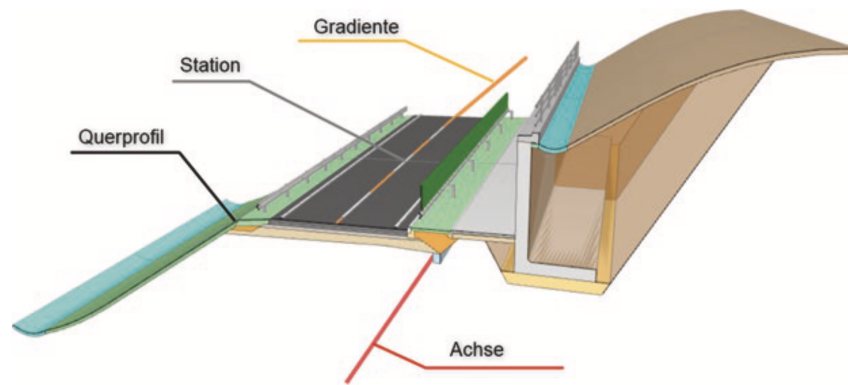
Grundelemente der Straßenplanung (BACH & STIEHLER, 2021)
